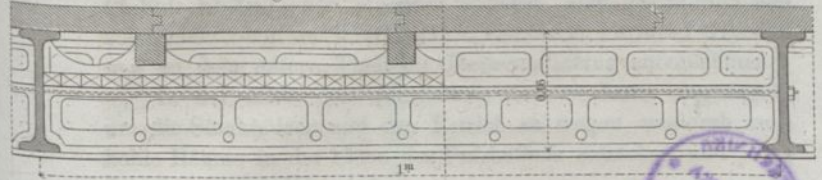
Grundriss des Fussbodens. (Q15)
